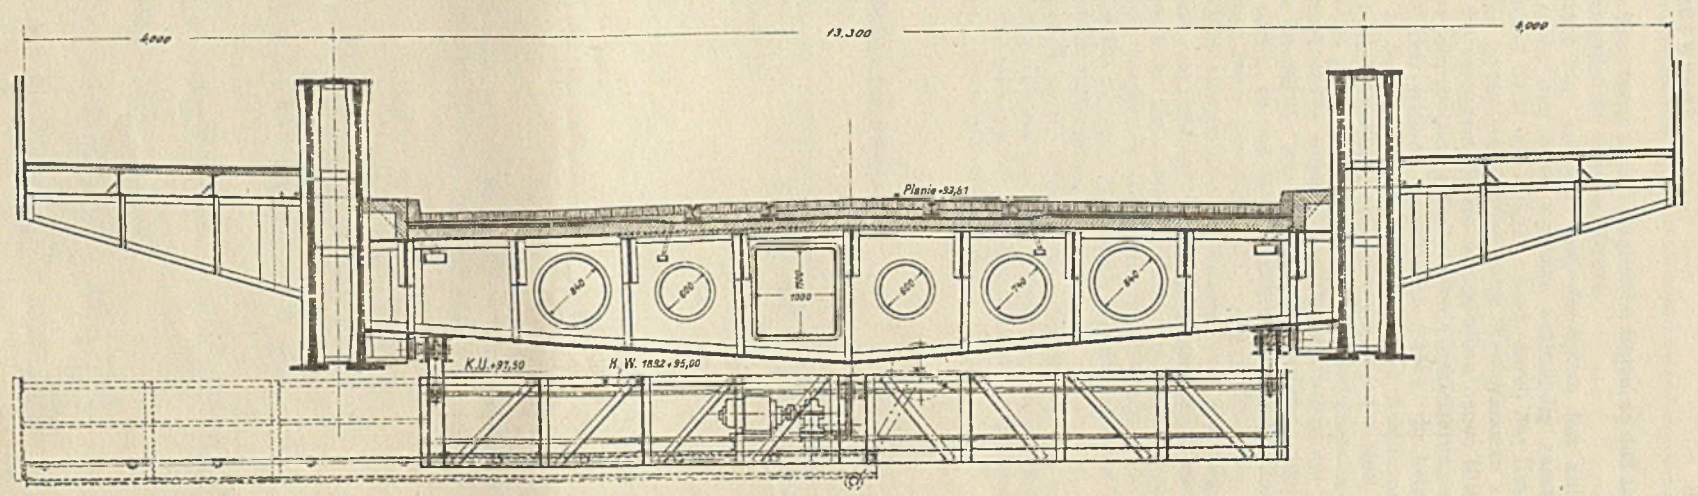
Querschnitt des Überbaues in Brückenmitte. 1:100.
